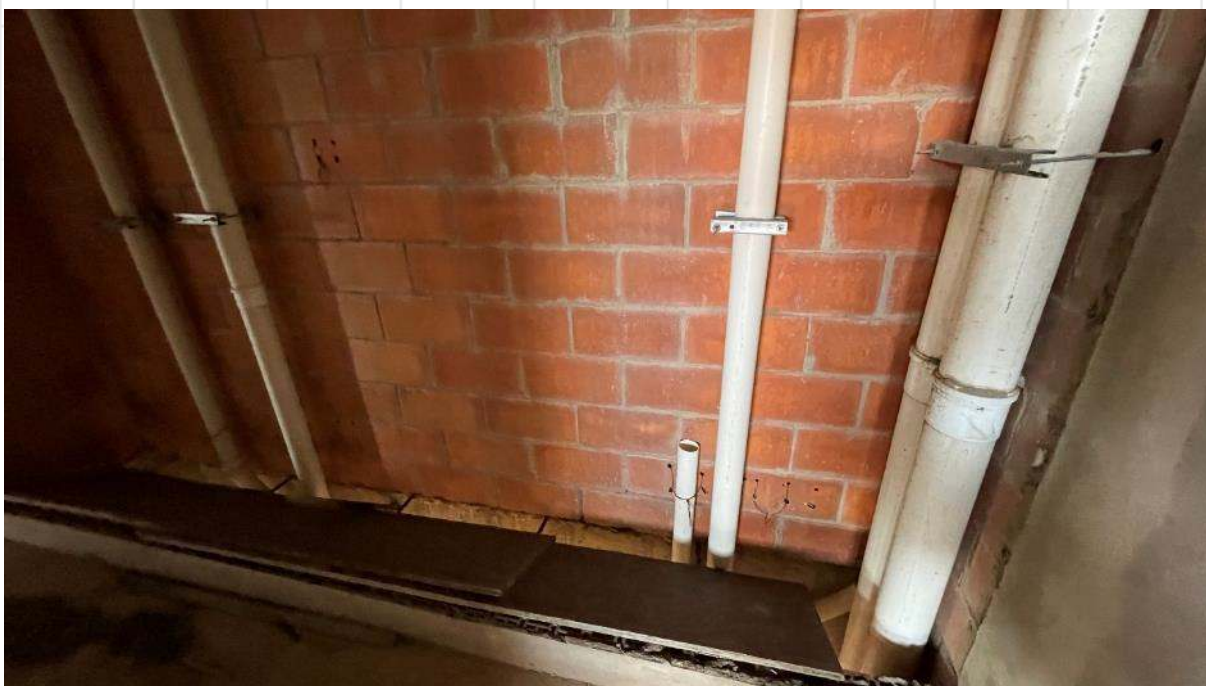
Primeiro pavimento. Destaque para o shaft de prumadas.
